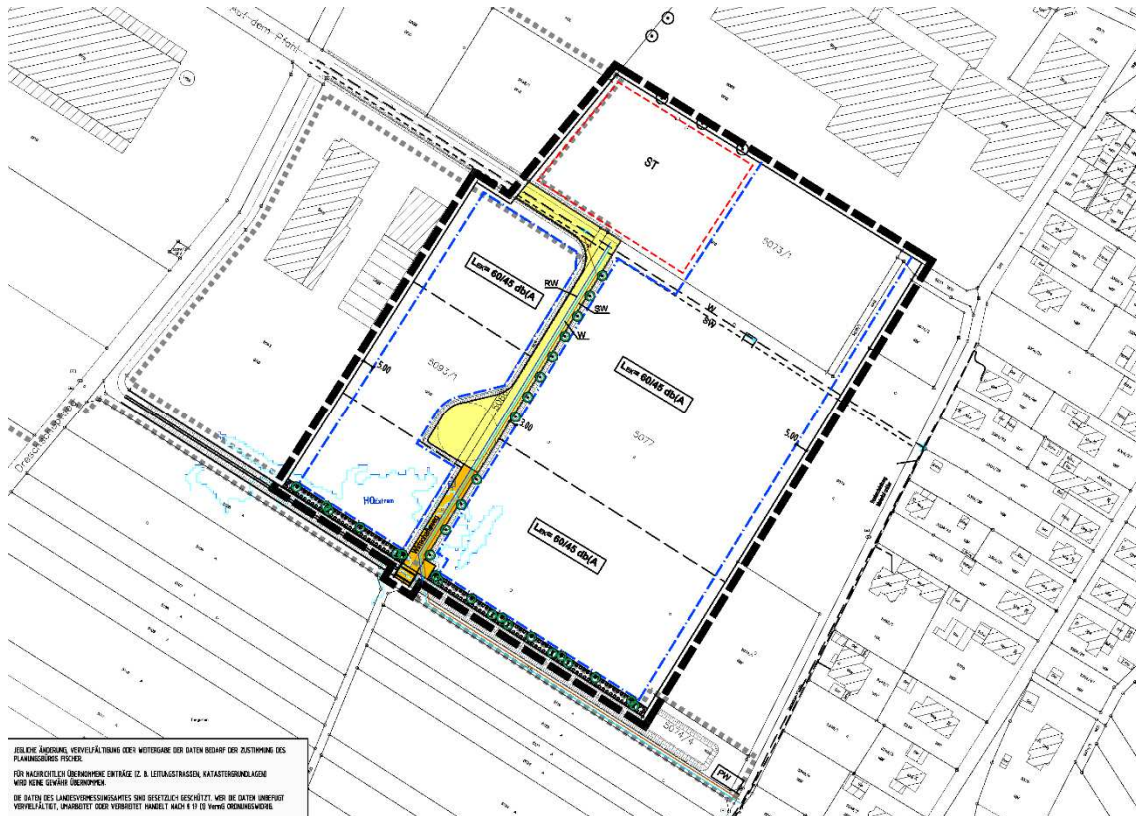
Übersicht B-Plan aus 2022 „Gewerbegebiet Dreschschopf III“ (Quelle Planungsbüro Fischer)
